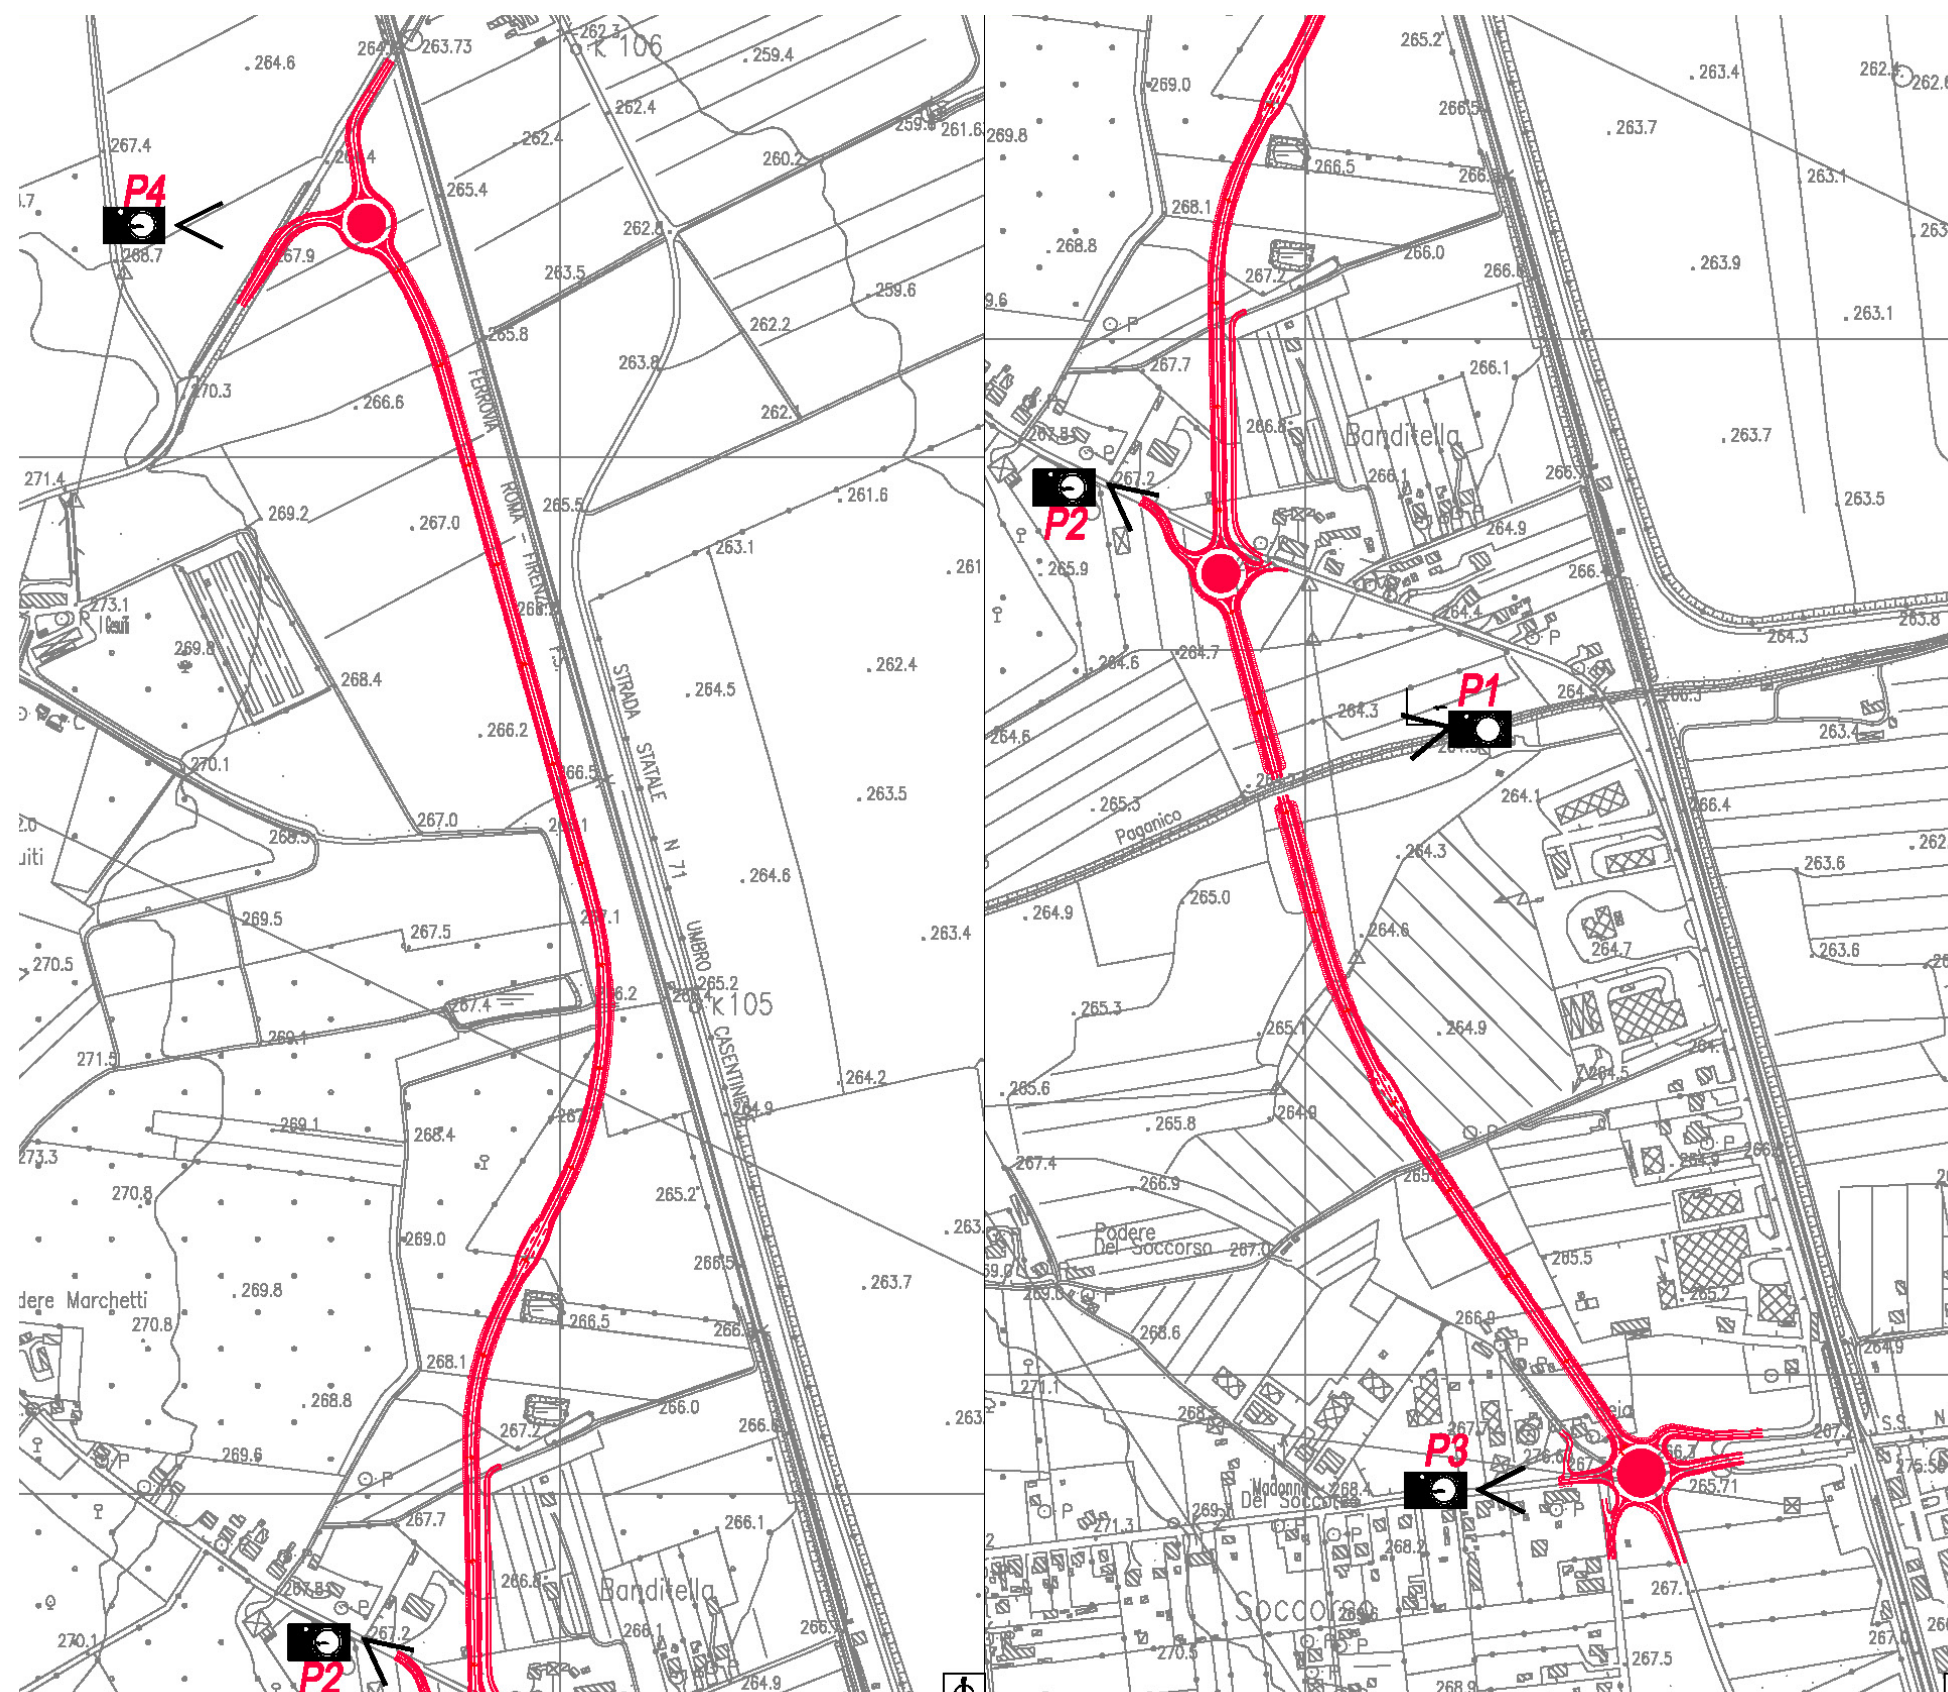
Planimetria su base CTR con ubicazione dei punti di vista utilizzate per i fotoinserimenti
